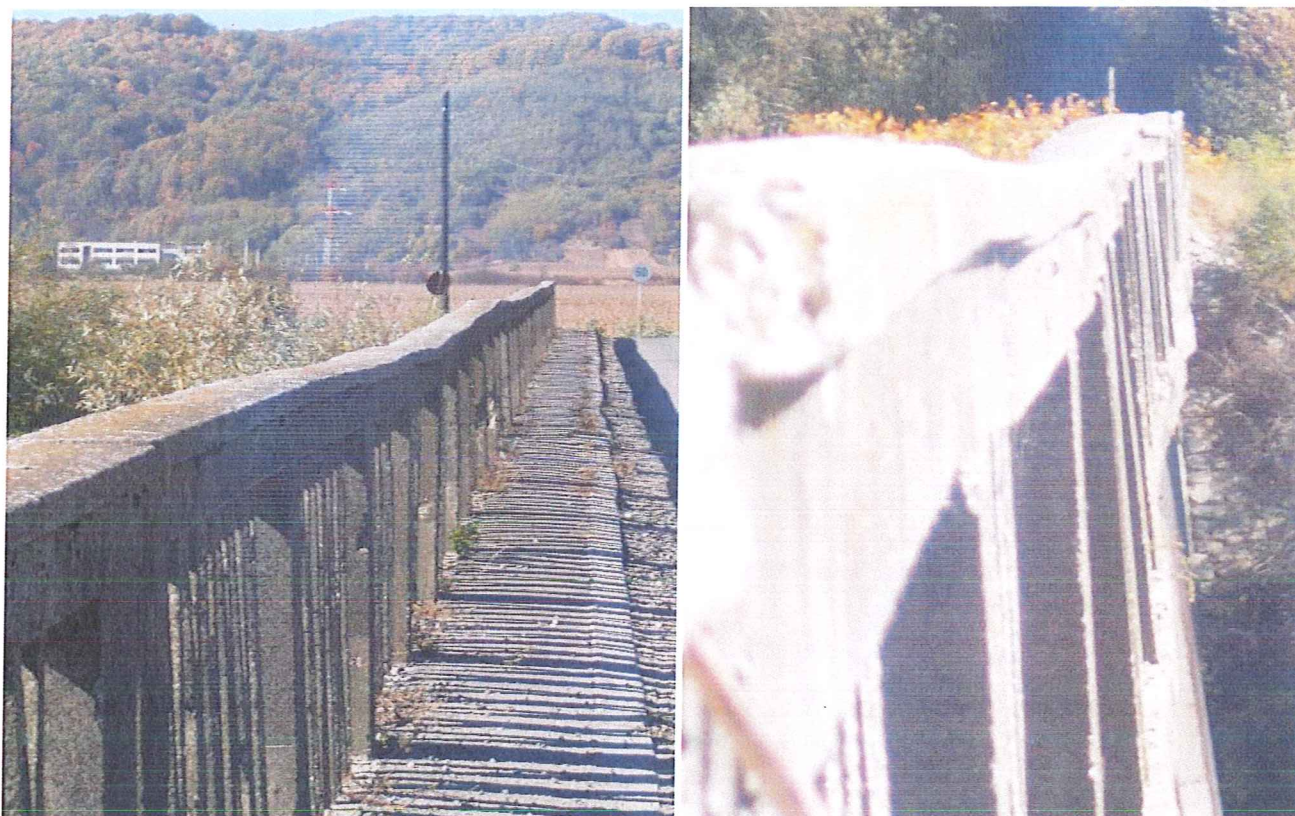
, 28. Deformații remanente (săgeți) consemnate la nivelul superior al parapetelor pietonale din beton
